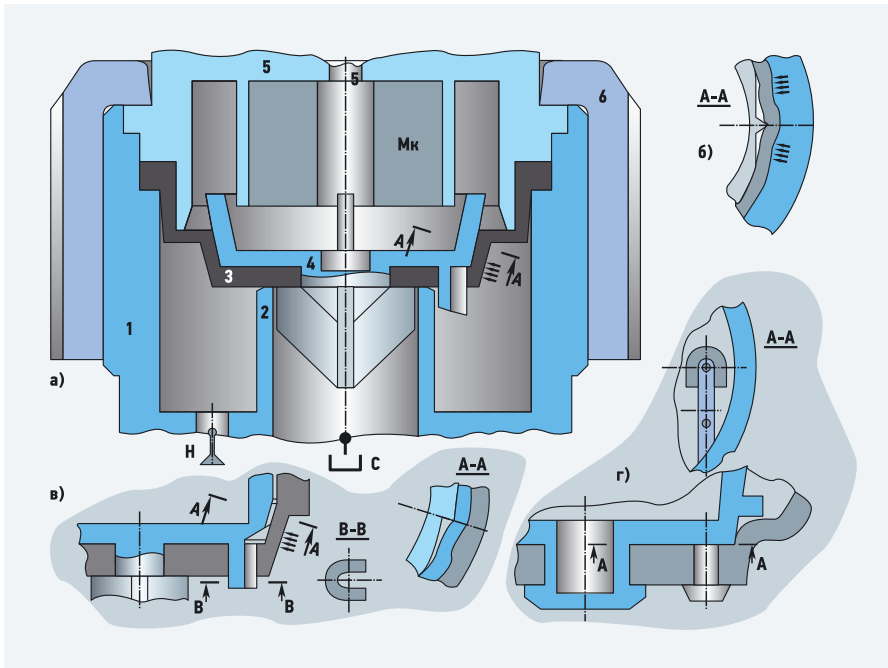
Схемы клапанов прочих конструкций (а — схема фирмы Siamp, б — схема жиклера в сечении, в — схема фирмы AlcaPlast, г — схема фирмы Wiquin; 1 — корпус; 2 — основное сопло; 3 — диафрагма; 4 — диск; 5 — крышка; 6 — накидная гайка; Н и С — напорная и сливная камеры, Мк — междроссельная камера)
